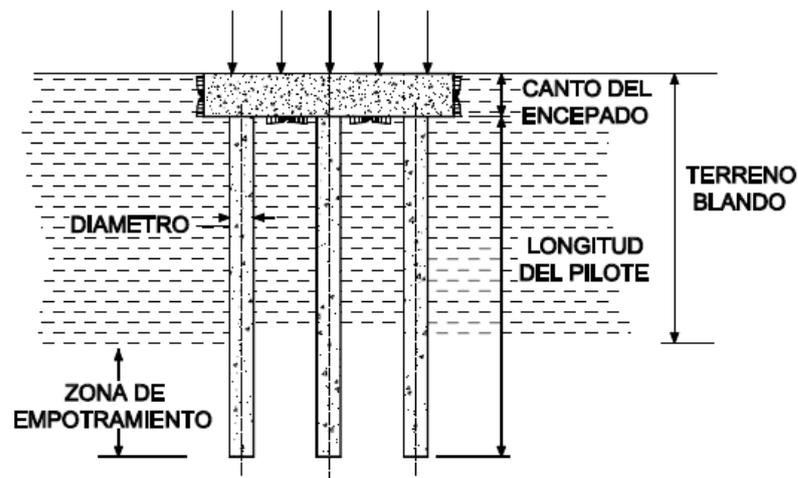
Estructura típica de cimentación por pilotes (Fuente: [29])
